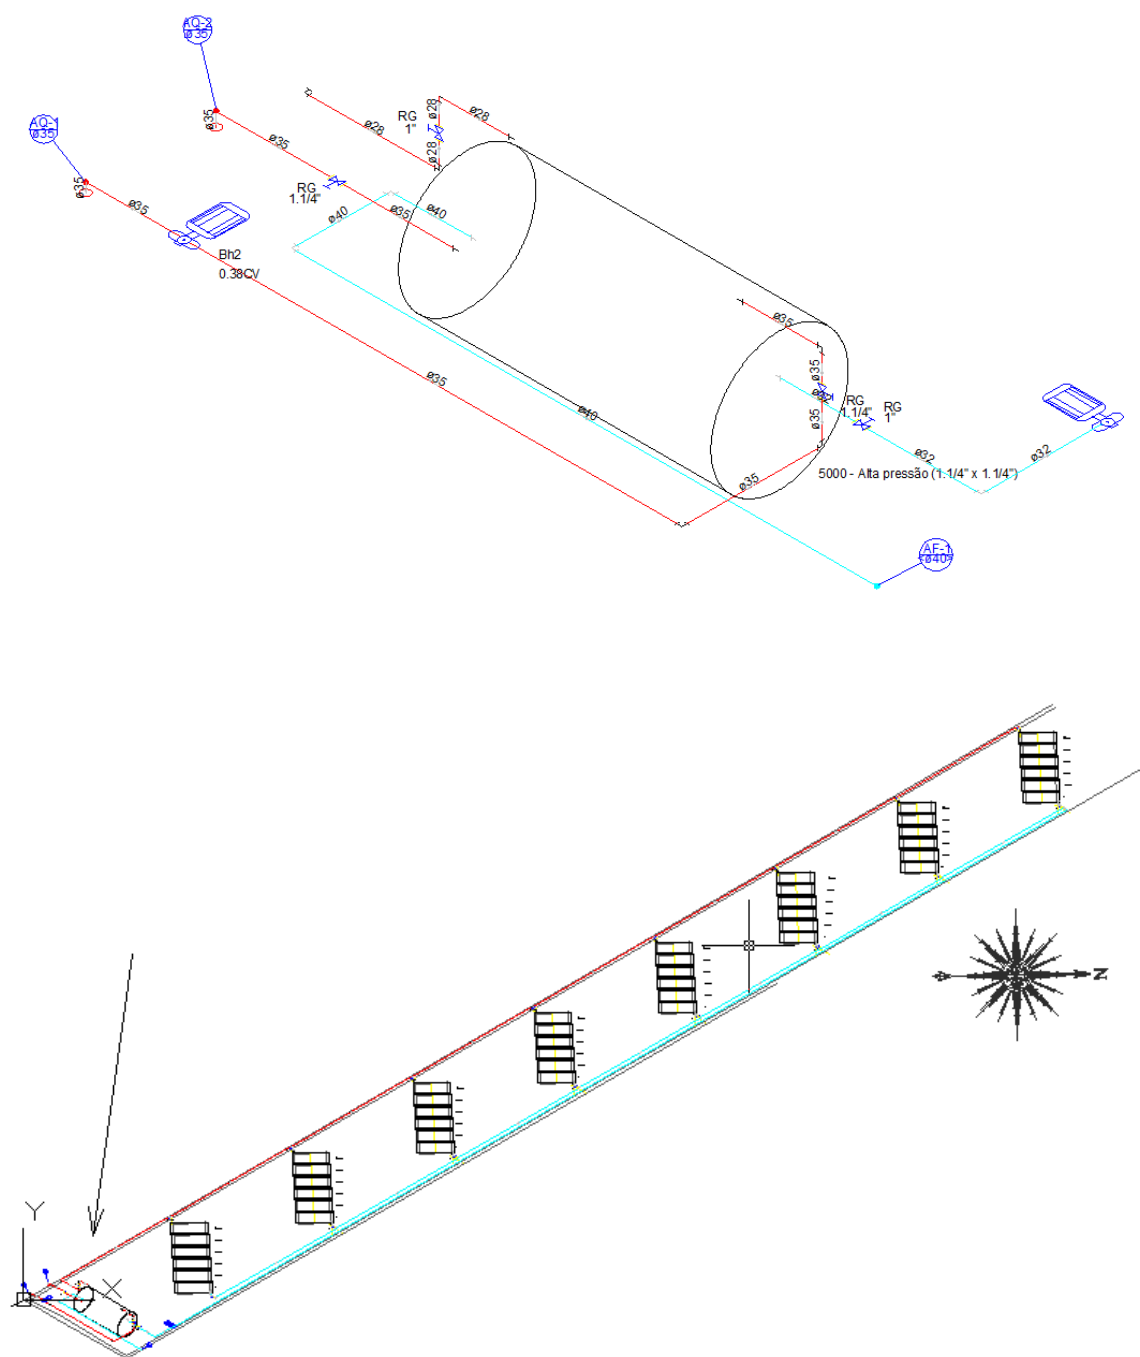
Planta baixa pavimento cobertura, posição placas e reservatório
